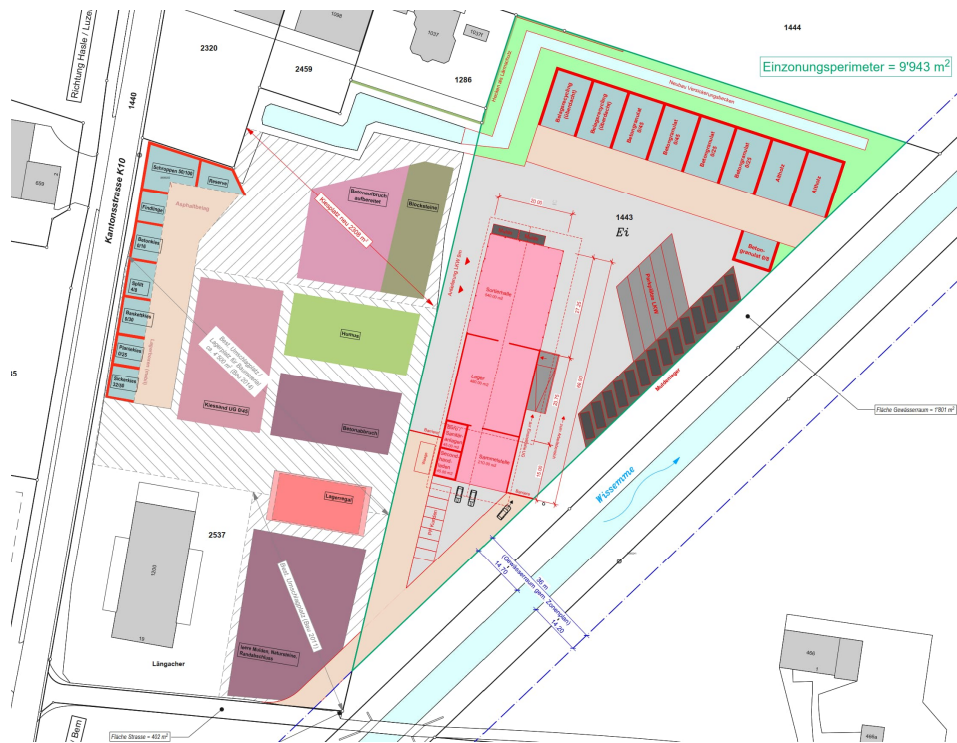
Auszug Situationsplan Vorstudie Recyclingcenter (Infraplan 25.11.2024)
